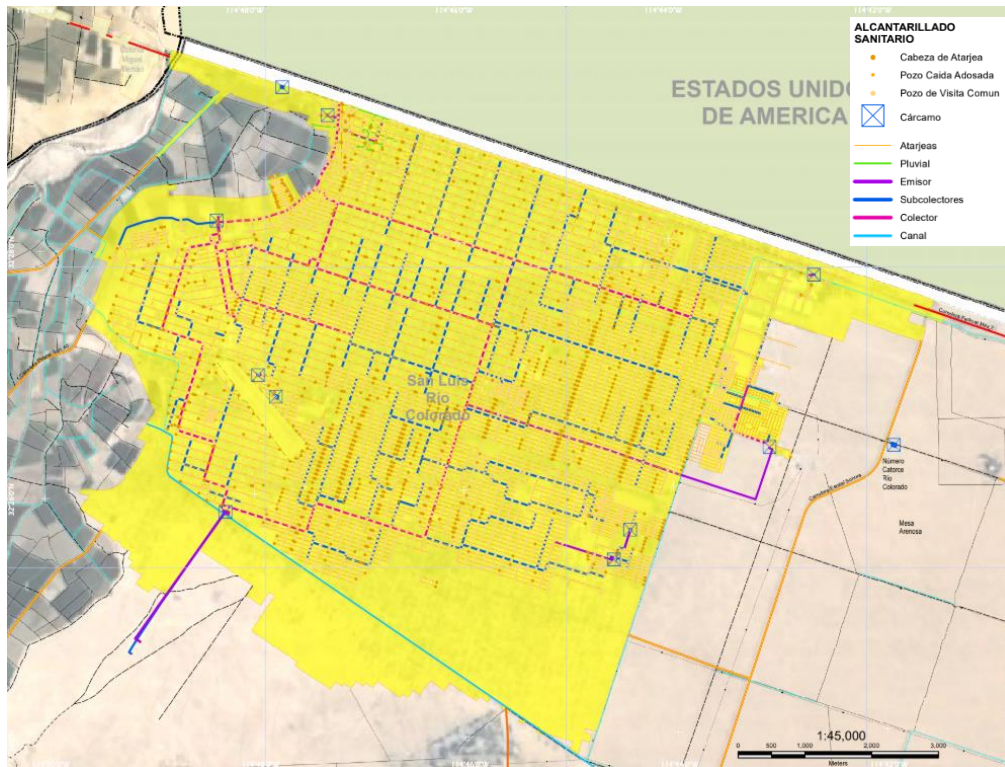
ALCANTARILLADO SANITARIO CENTRO DE POBLACIÓN DE SAN LUIS RÍO COLORADO
